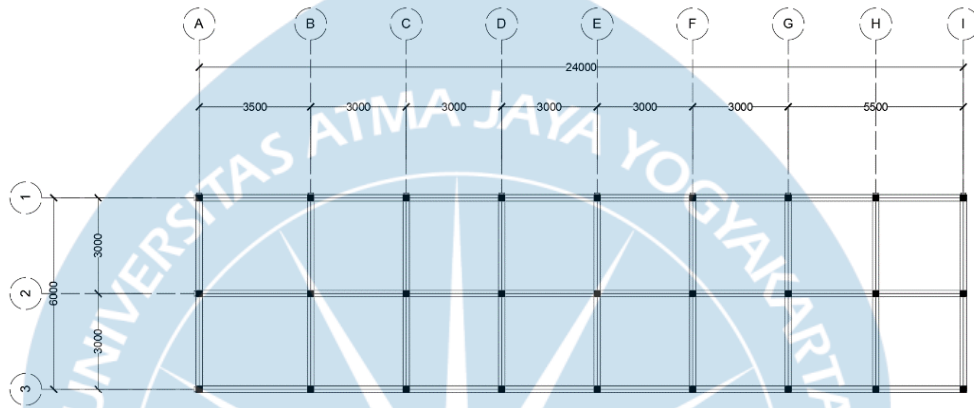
Denah Balok-Kolom Bangunan A Lantai 1
